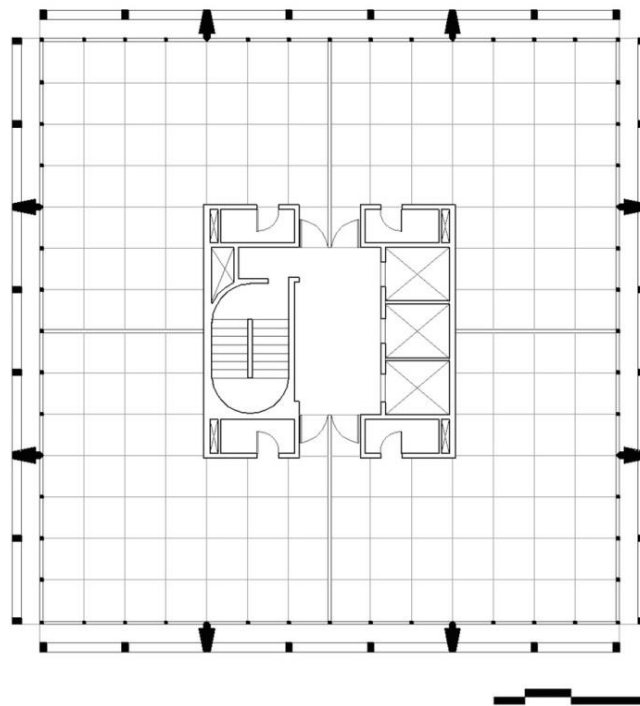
Planta do pavimento tipo do Edifício Acal (Fonte: ESPALLARGAS, 2016)
